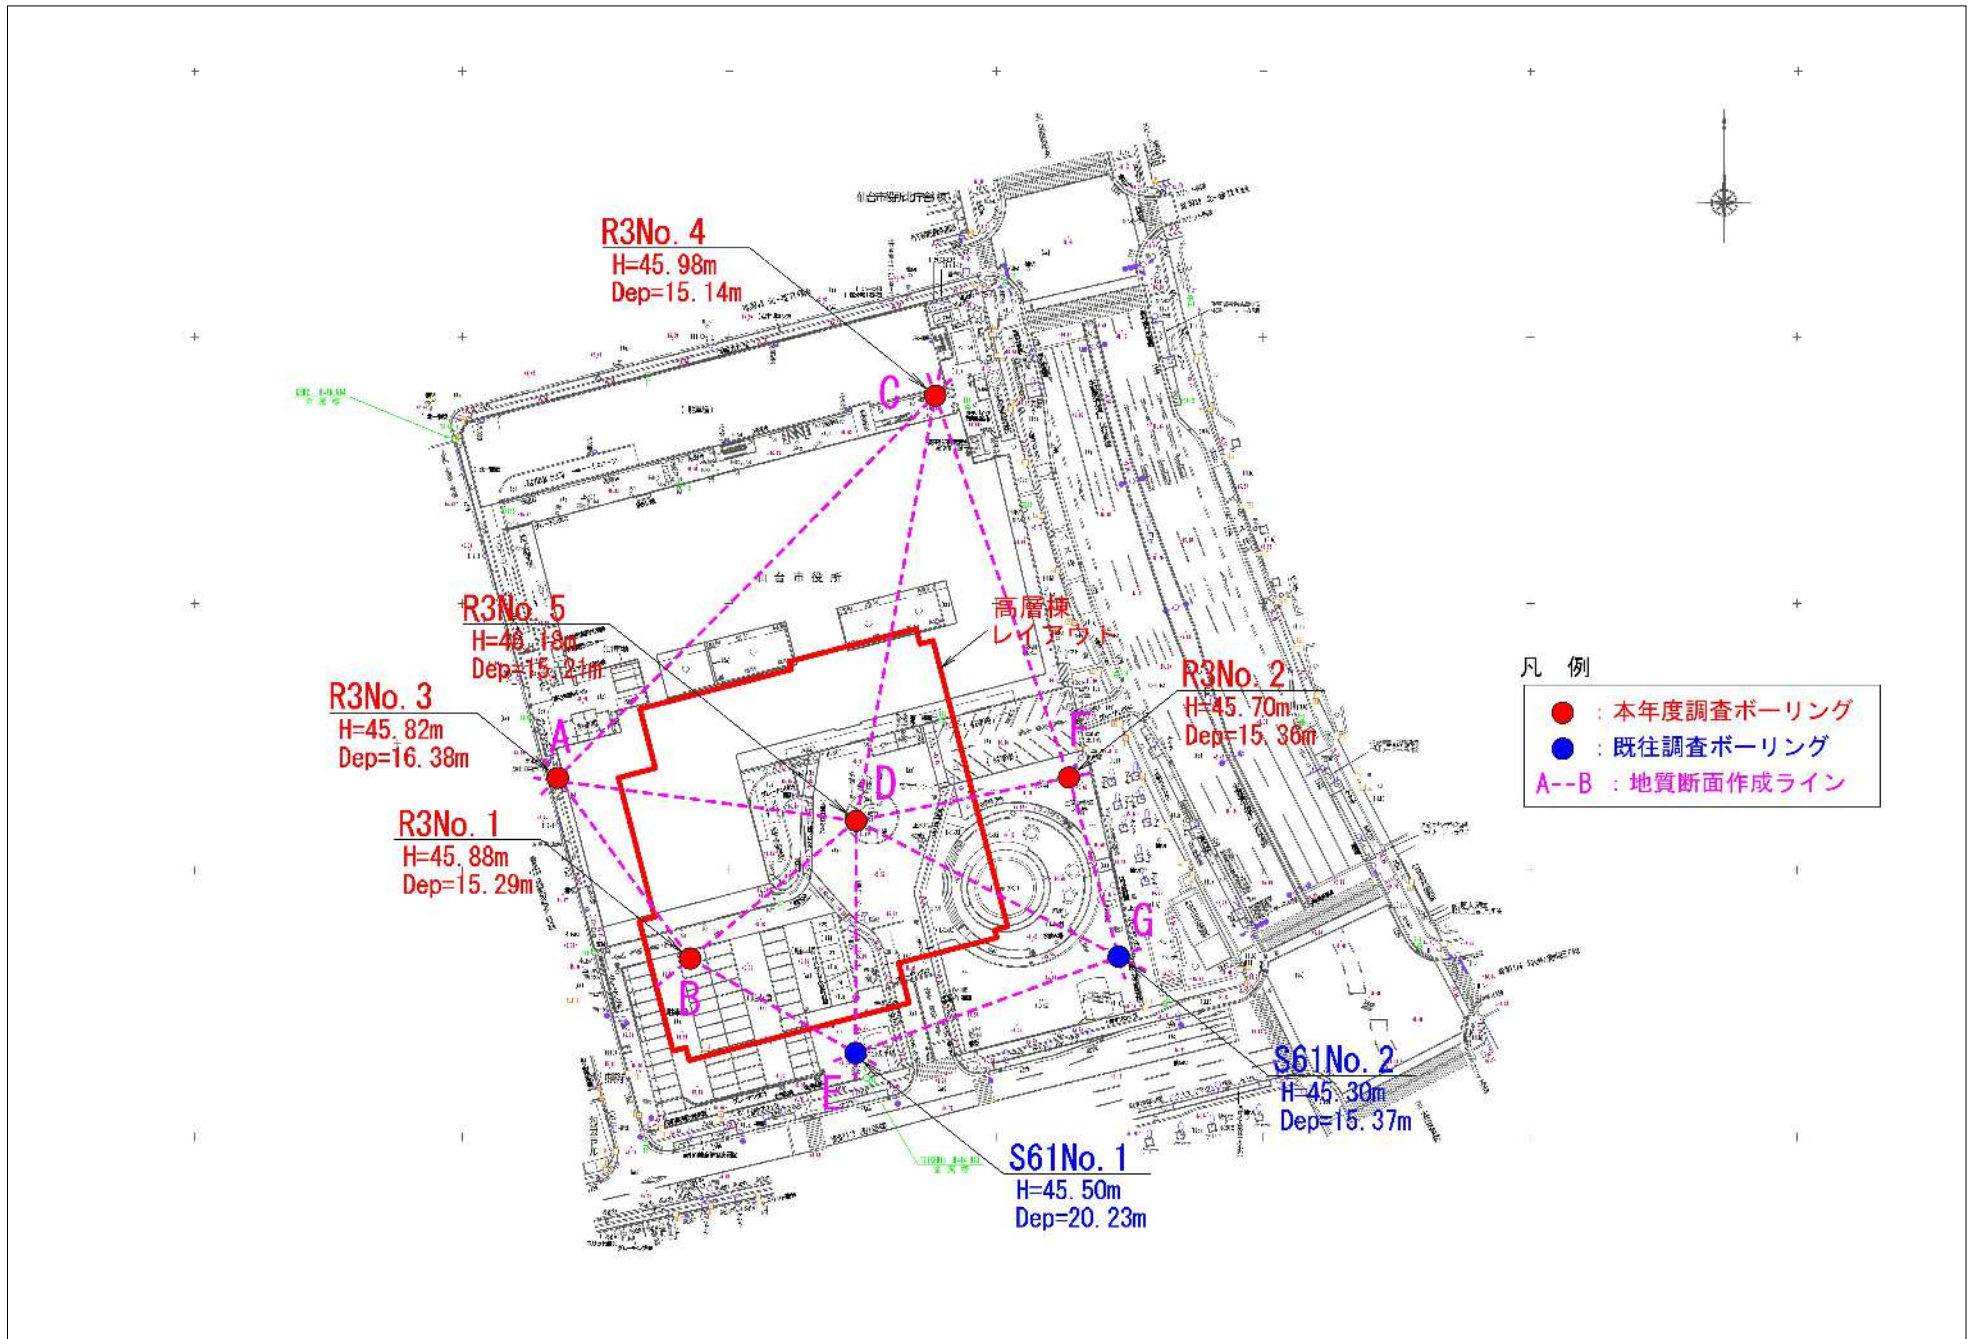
調査位置平面図 (縮尺: 1/1,000)
